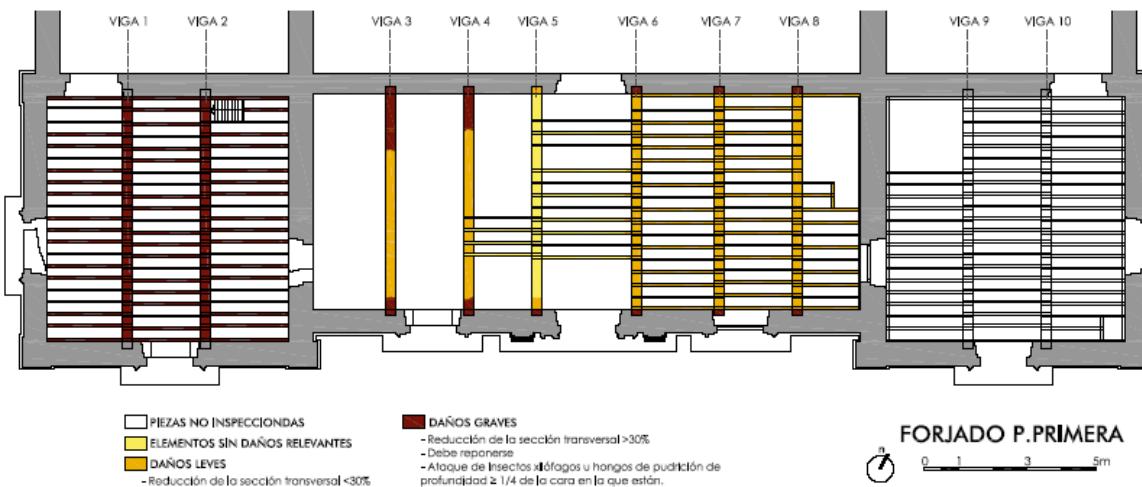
Estructura de madera: daños inspeccionados. Timber structure: damage identified.
